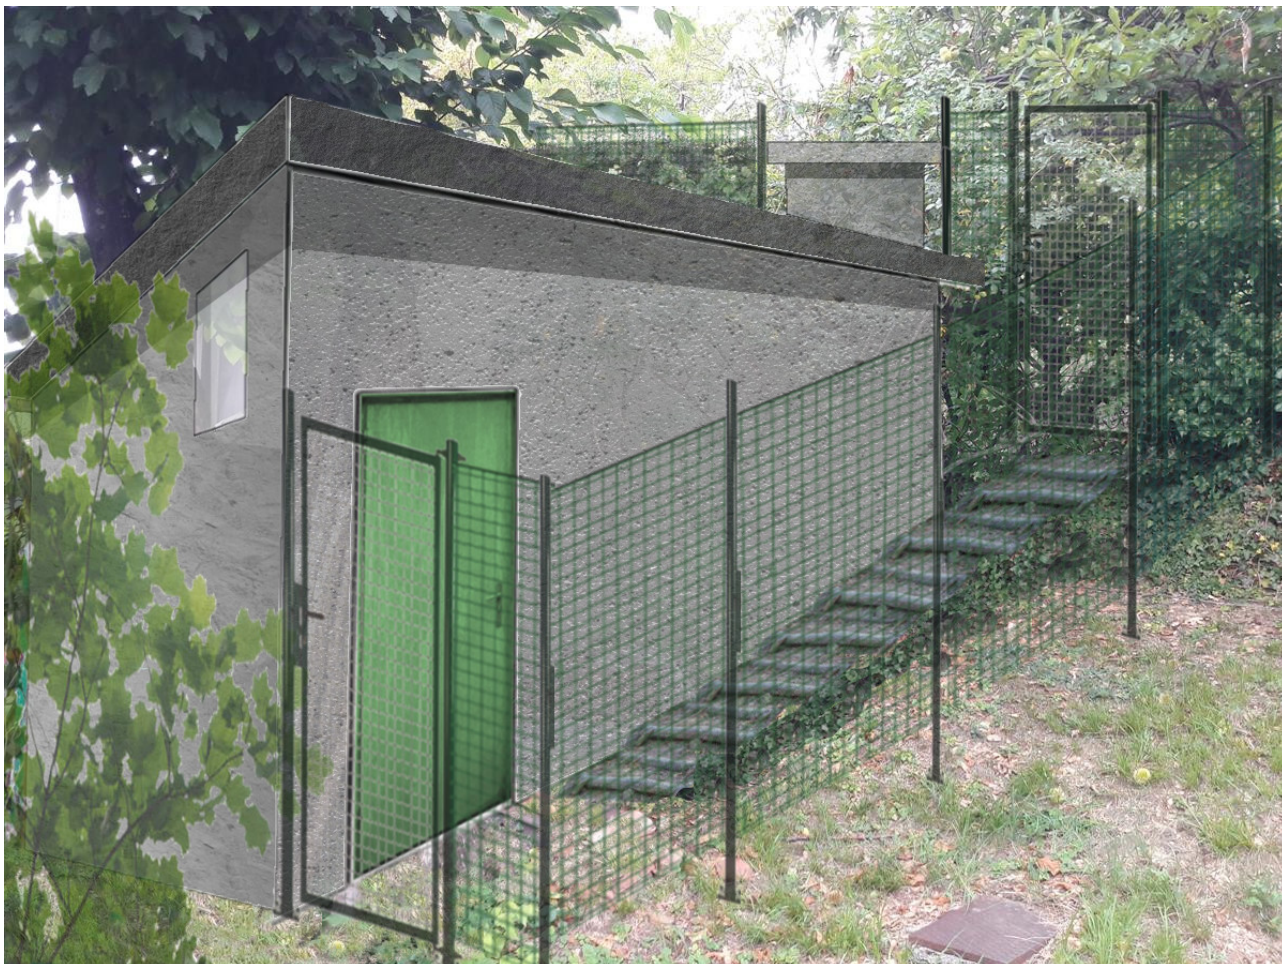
vista della porta di ingresso al serbatoio sul fronte sud (da murare)
